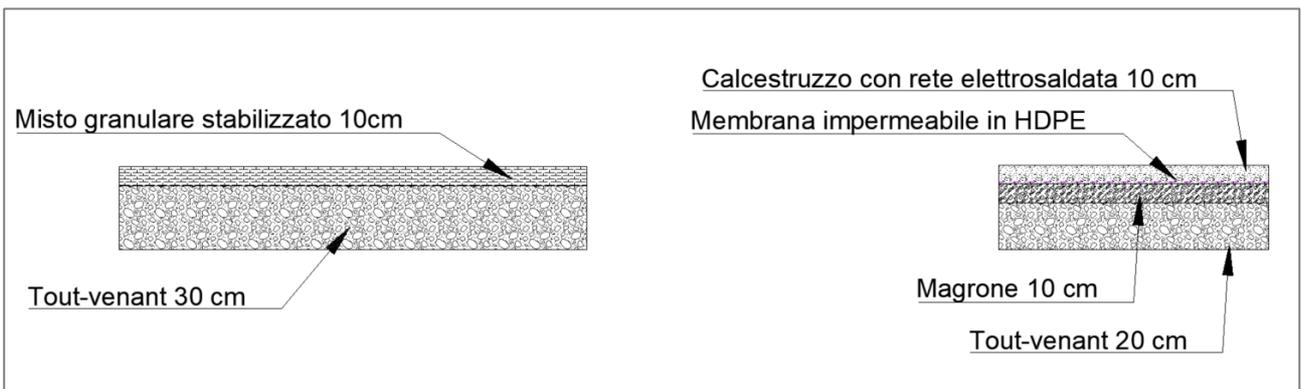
Sezioni trasversali dei pacchetti planimetrico con indicazione degli apprestamenti di cantiere
